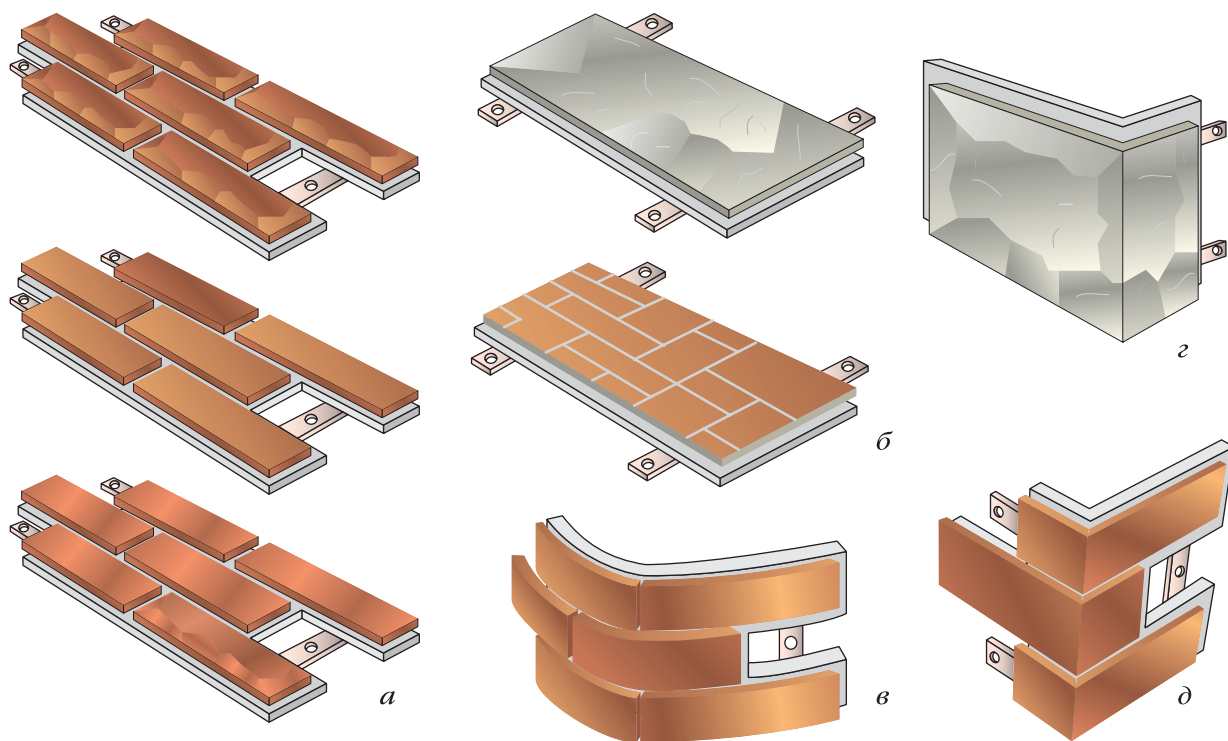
Бетонные облицовочные панели компании «Каньон Маркетинг»: а — стеновые; б — цокольные; в — наружная угловая полукруглая; г — угловая цокольная; д — угловая стеновая
